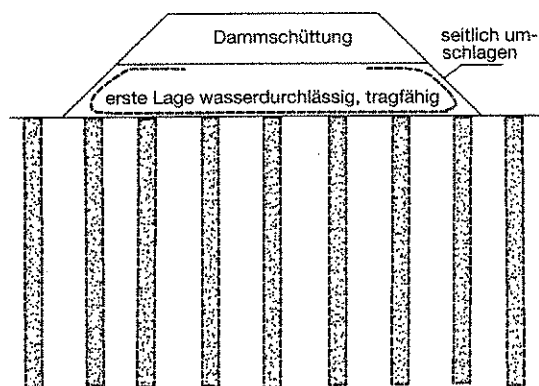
Damm mit Sohlbewehrung über eingedrückten geotextilummantelten Sand-/Kiessäulen (Durchmesser ca. ≤ 30 cm)
